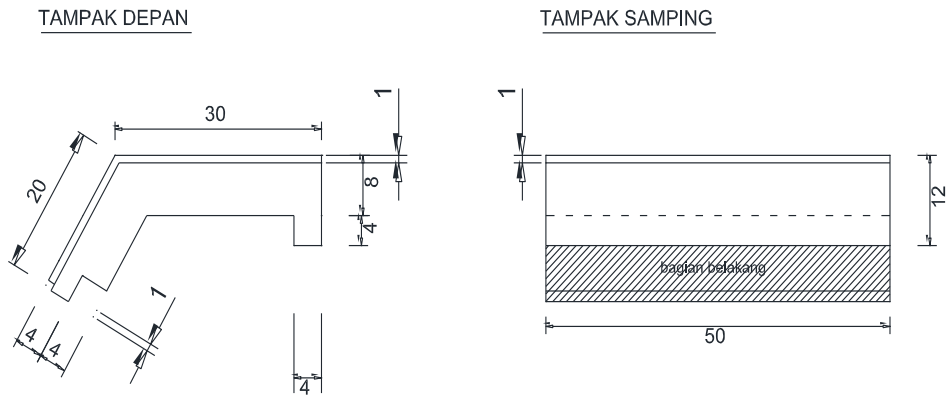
Modul Dinding atau Lantai Tipe-S Beton Pracetak Modular
